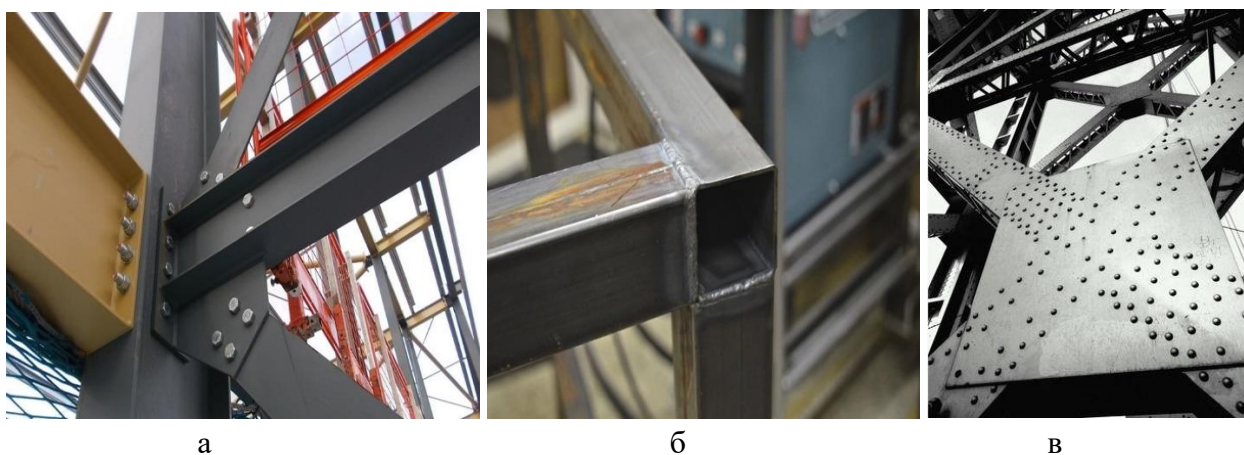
Види з'єднань металевих конструкцій: а – болтове; б – зварне; в – заклепувальне
